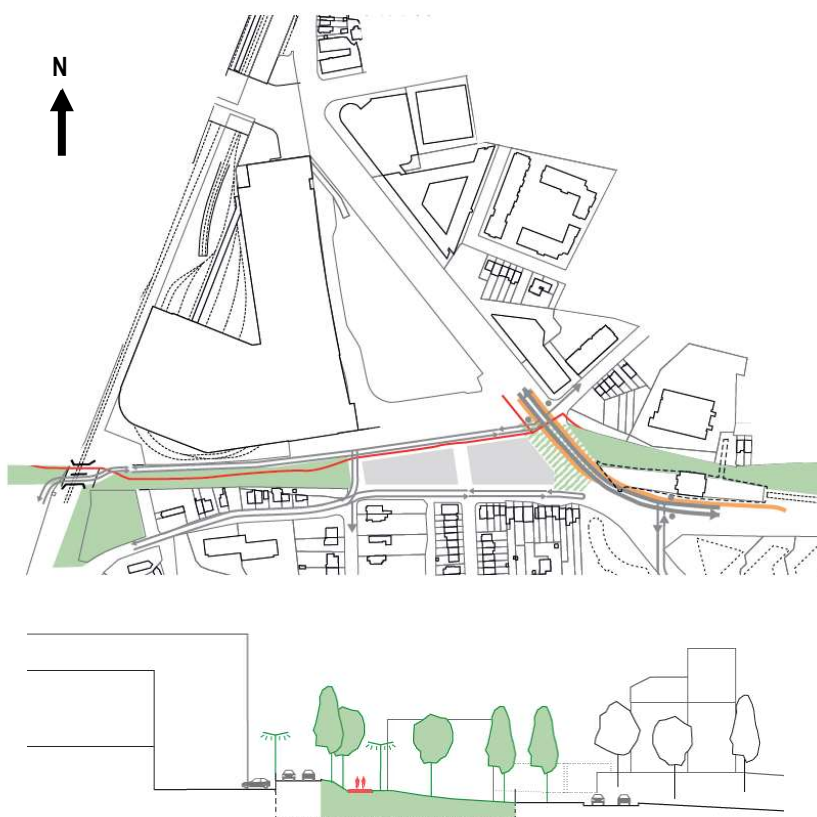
Localisation (en haut) et coupe transversale (en bas) de l'espace vert Michiels (ORG, 2018)
